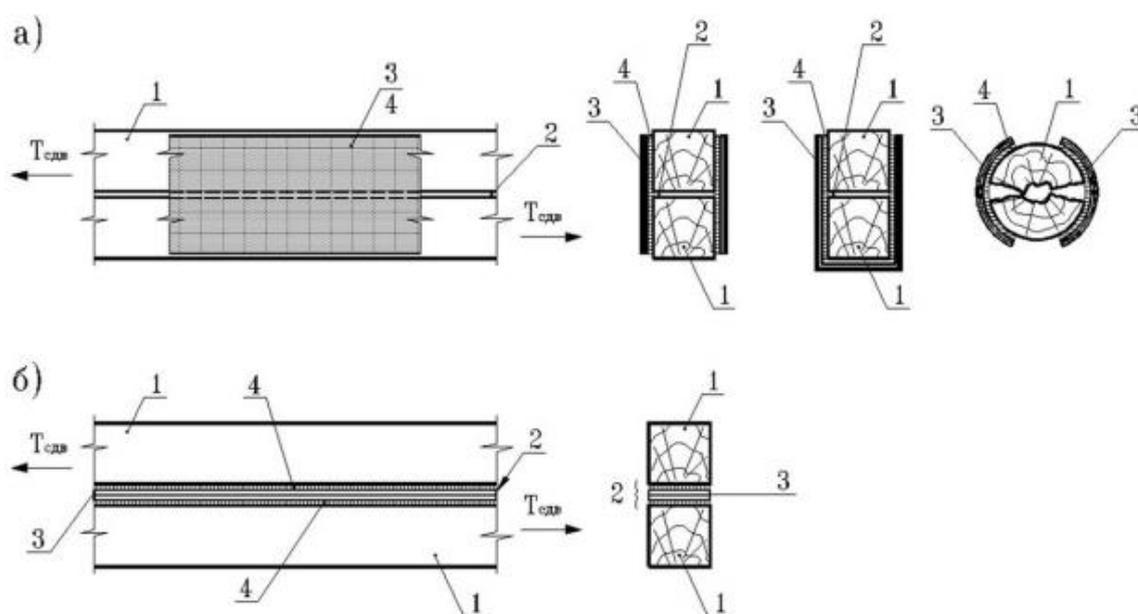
Соединение деревянных элементов композиционным материалом на основе эпоксидной матрицы и стеклоткани: а — внешней обклейкой боковых поверхностей соединяемых элементов в виде боковых накладок или обоймы («КМ-обклейка»); б — адгезионным вкладышем, установленным между смежными плоскостями соединяемых элементов («КМ-вкладыш»): 1 — соединяемые деревянные элементы; 2 — шов сплачивания; 3 — композиционный материал, сформированный на конструкции; 4 — клеевой шов, создающий адгезионные связи на границе раздела «КМ-древесина».
